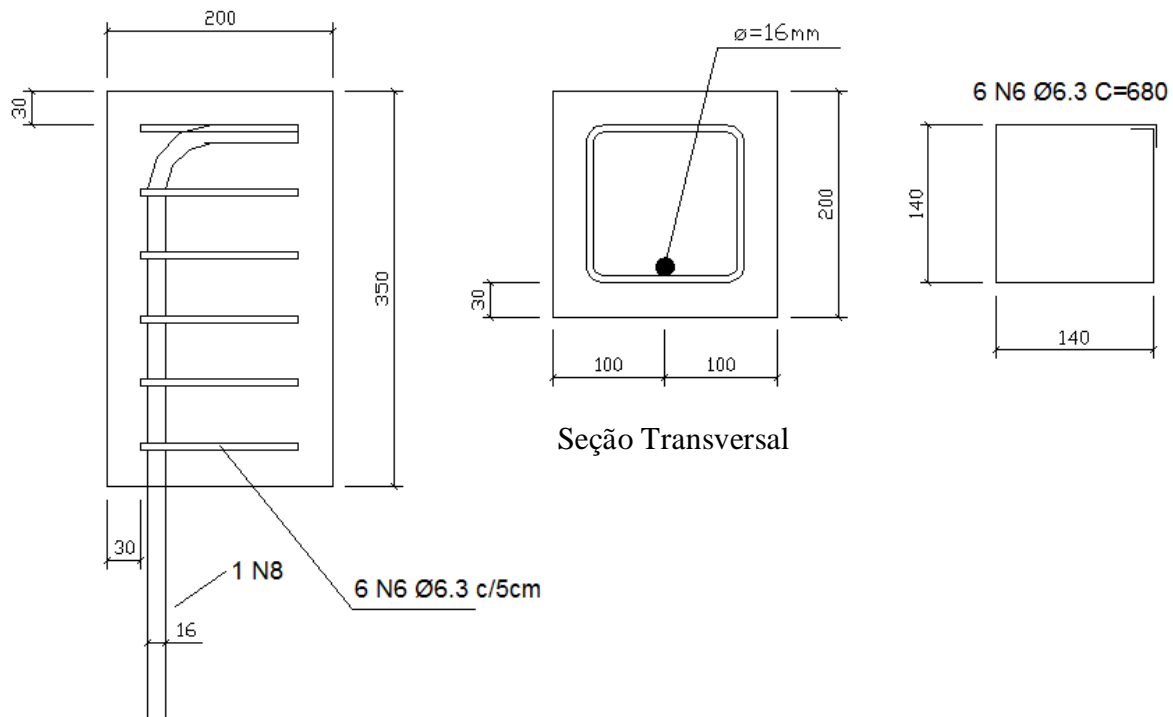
Detalhe do modelo de arrancamento com barras retas de 16 mm com estribos
